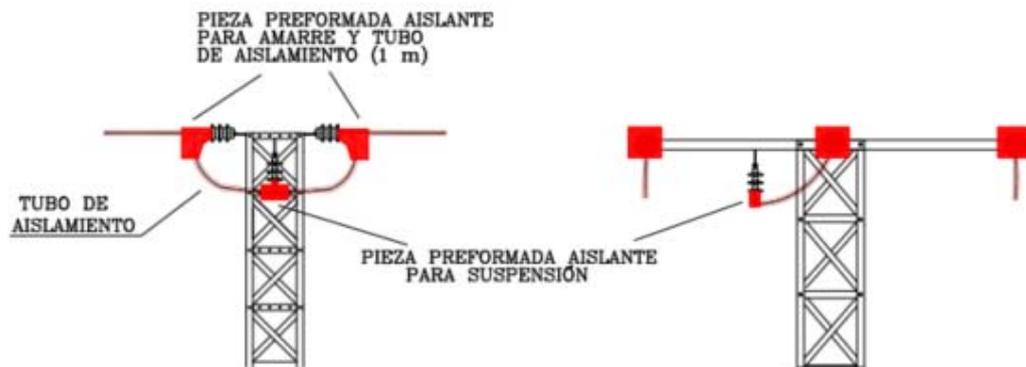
Adecuación de apoyo de amarre con cadena de suspensión para el puente central
